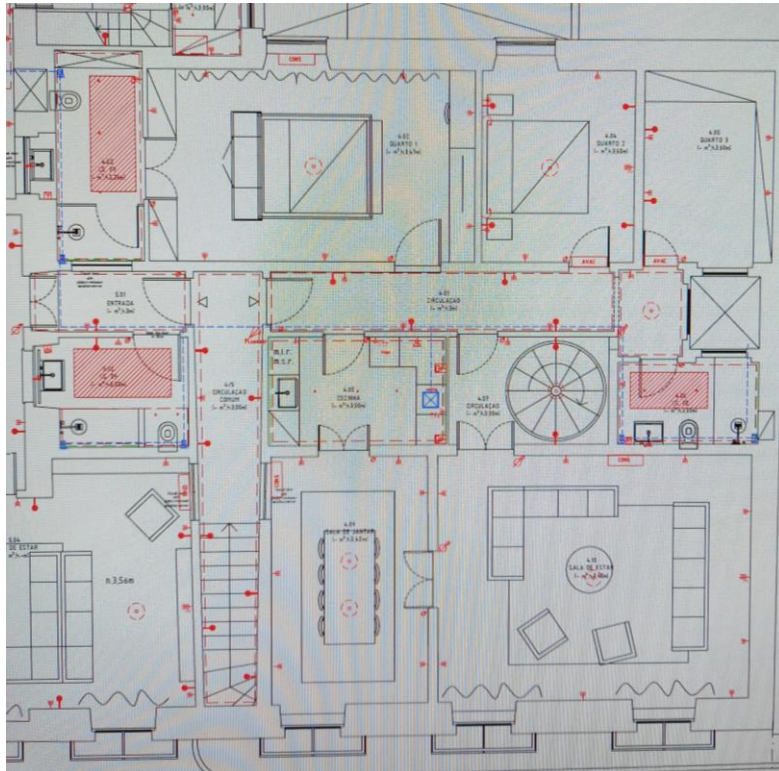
Planta de eletricidade. Fonte: Atelier Studio Arte
